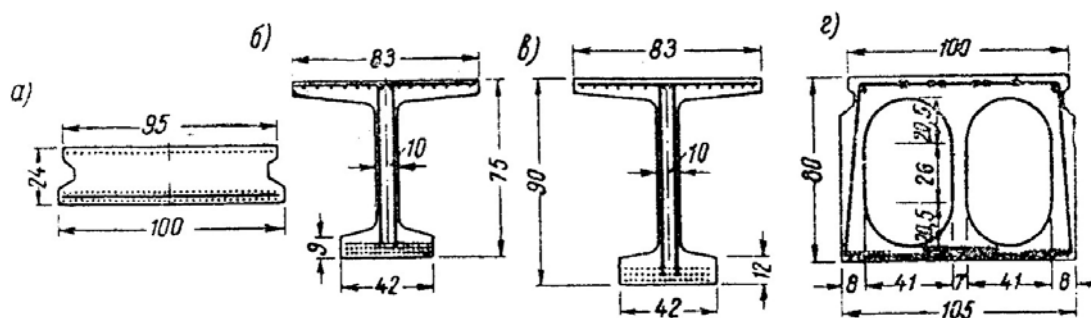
Поперечний переріз попередньо напружених струнобетонних балок
